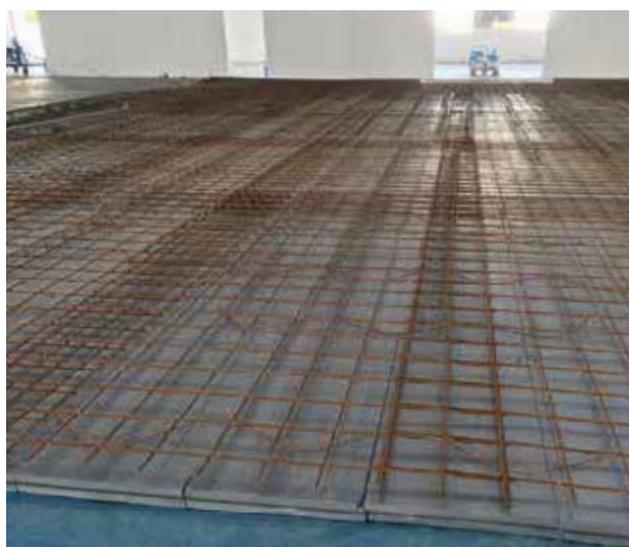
Pavimenti industriali isolati con RAVATHERM™ XPS X 500/700 SL
